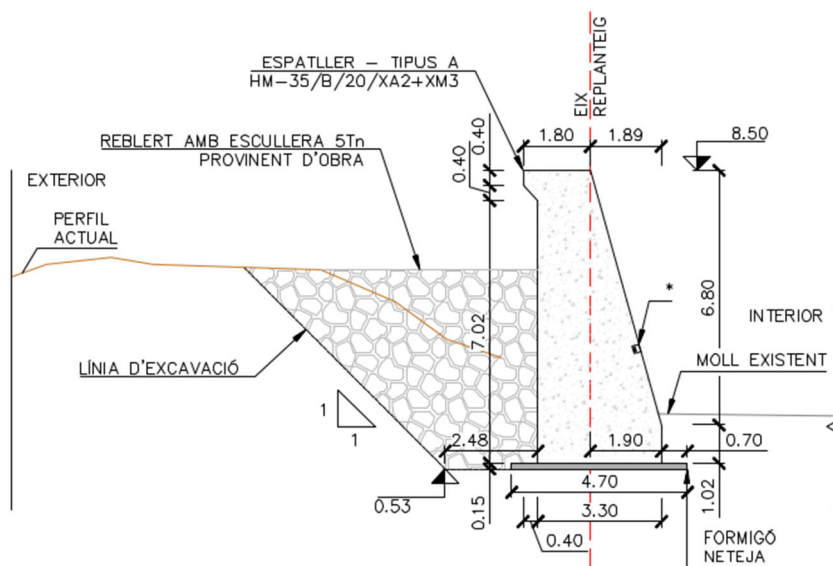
Secció tipus del nou espalller emplaçat a la zona del colze.
